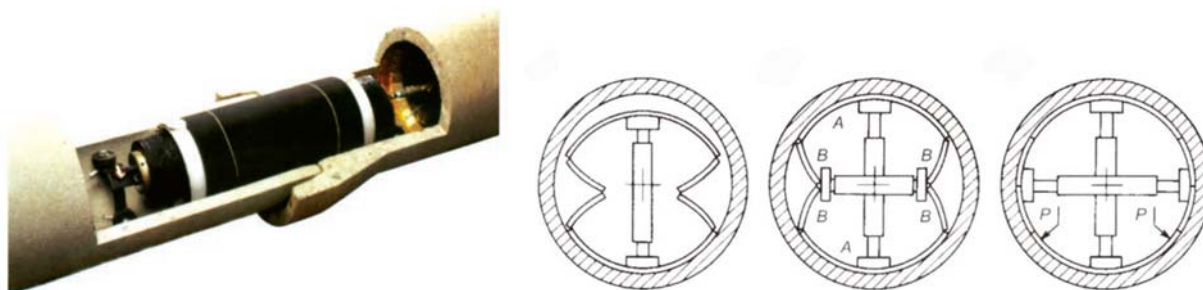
Фрагмент трубопровода с ремонтной гильзой внутри. Схема установки шарнирной тонкостенной облицовки: а – ввод сложенной гильзы в трубопровод; б – последовательное разжатие домкратами сегментов А и В; в – нагнетание полиуретановой мастики Р
